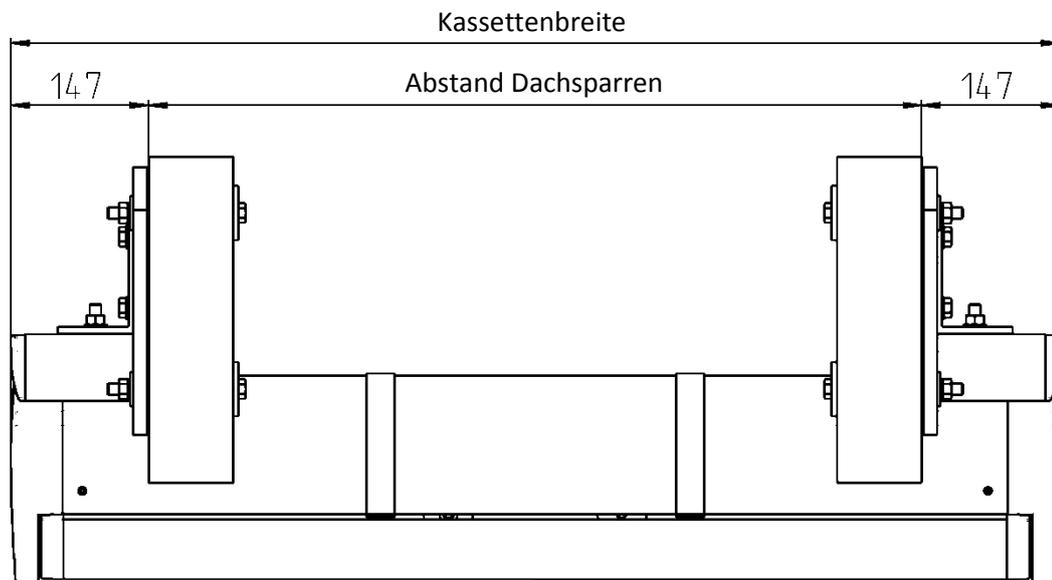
Standard Dachsparrenbefestigung mit Dachsparrenhalter und Montageplatte
